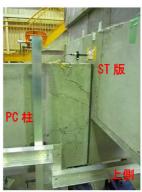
No2 正曲げ試験体 R=1/75 状態ひび割れ状況
